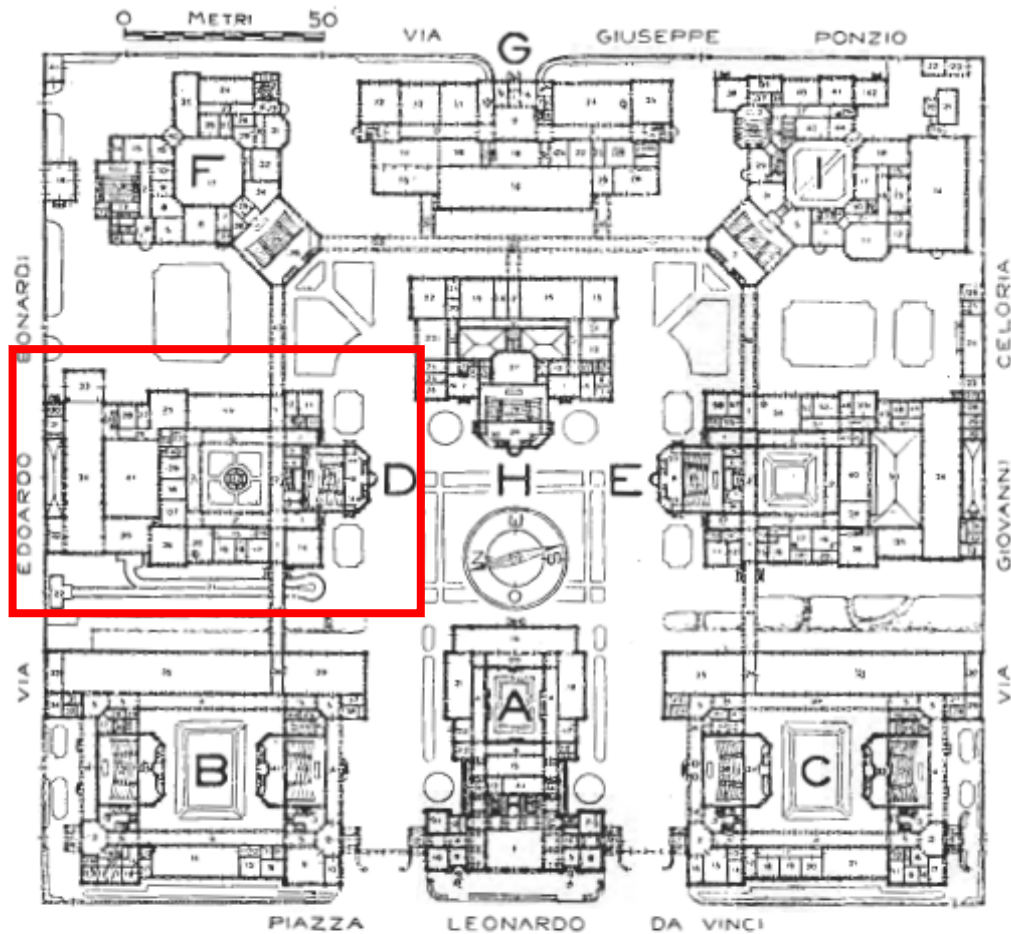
Vista aerea con individuazione dell' Edificio 4 (1927)
